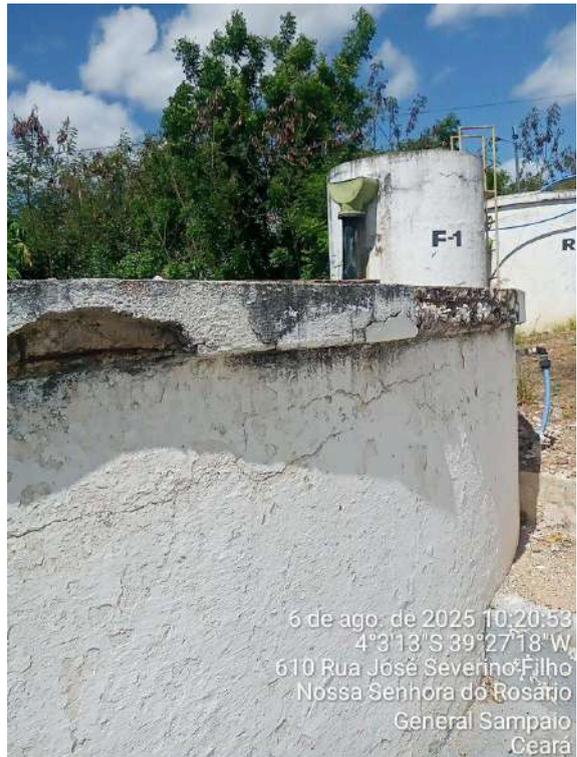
ETA/RAP-03: pintura e laje deterioradas.
